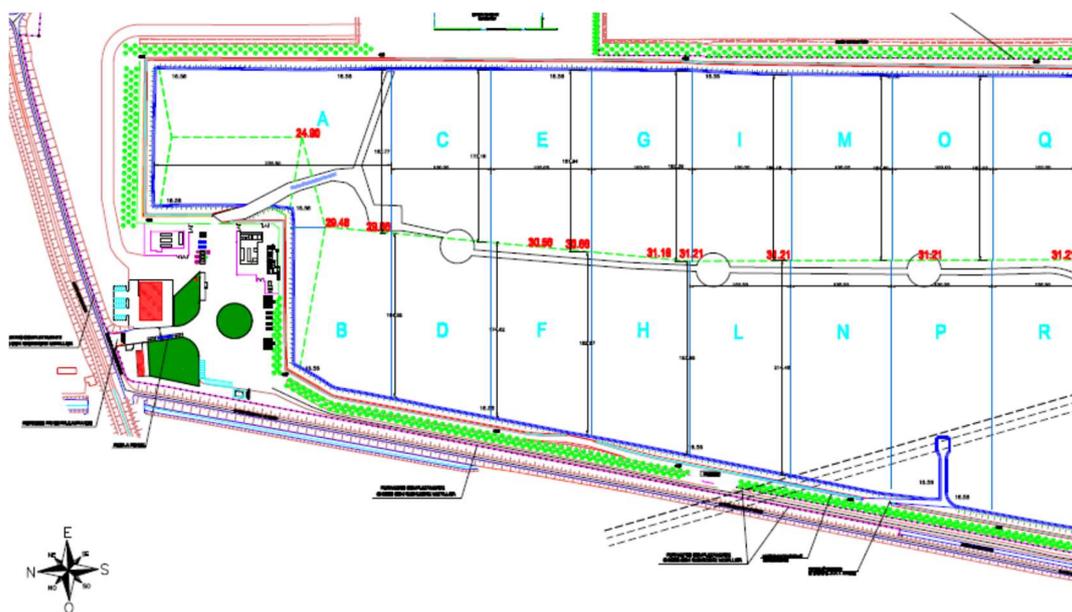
Planimetria generale della sequenza di coltivazione dell'impianto
